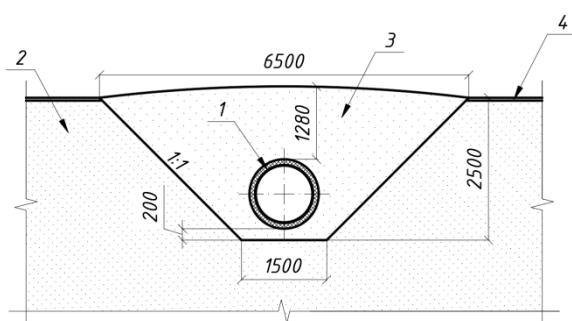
Схема подземной прокладки трубопровода в песчаном мёрзлом грунте: 1 – тело трубопровода; 2 – песчаный грунт основания; 3 – песчаный привозной грунт обратной засыпки; 4 – моховый слой
